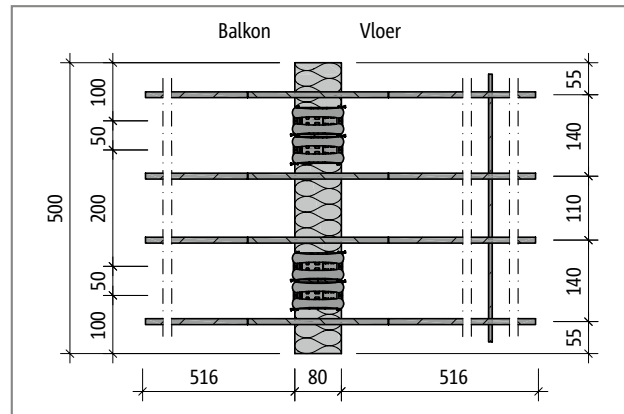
Schöck Isokorb® T type Q-E-Z-V5 bij R0: Zijaanzicht
